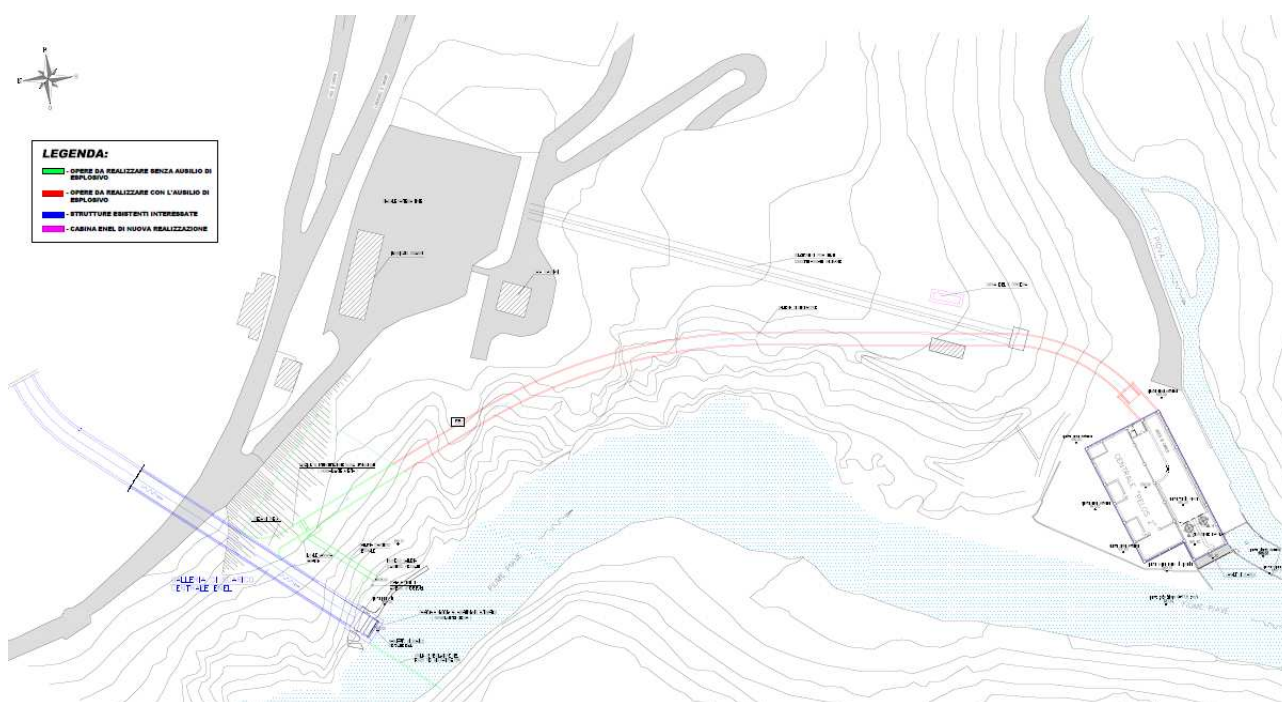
Estratto Tav. 2 - Planimetria generale impianto PELOS 2
